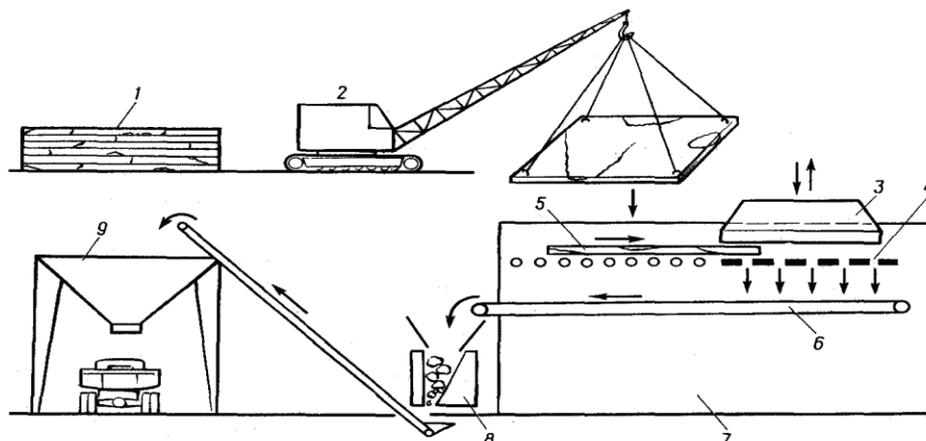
Схема установки по переработке бракованных железобетонных изделий:
